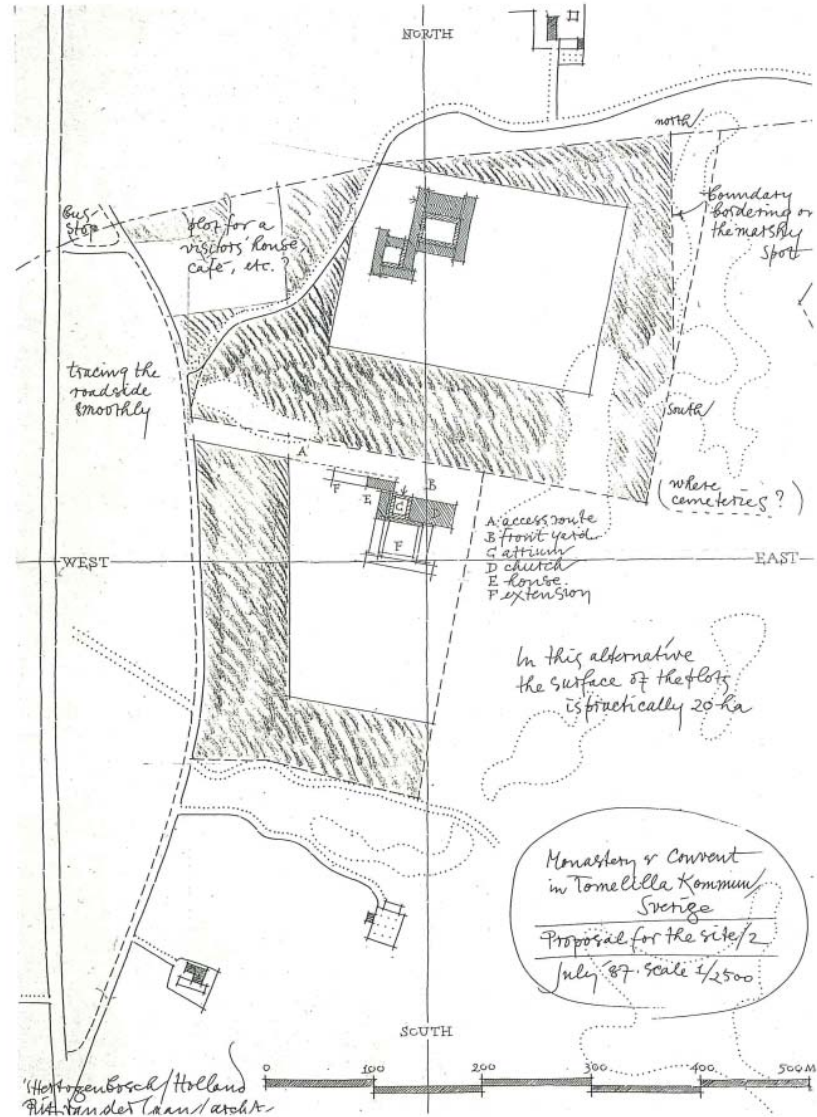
Planimetria generale di progetto con localizzazione dei due monasteri
